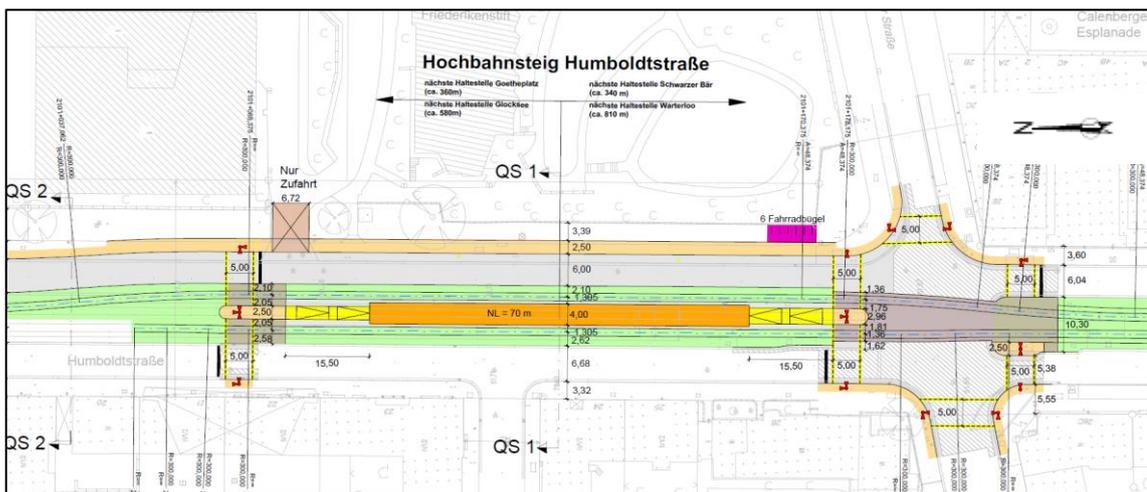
Lageplan Variante 2 Mittelhochbahnsteig Humboldtstraße (Ausschnitt)
